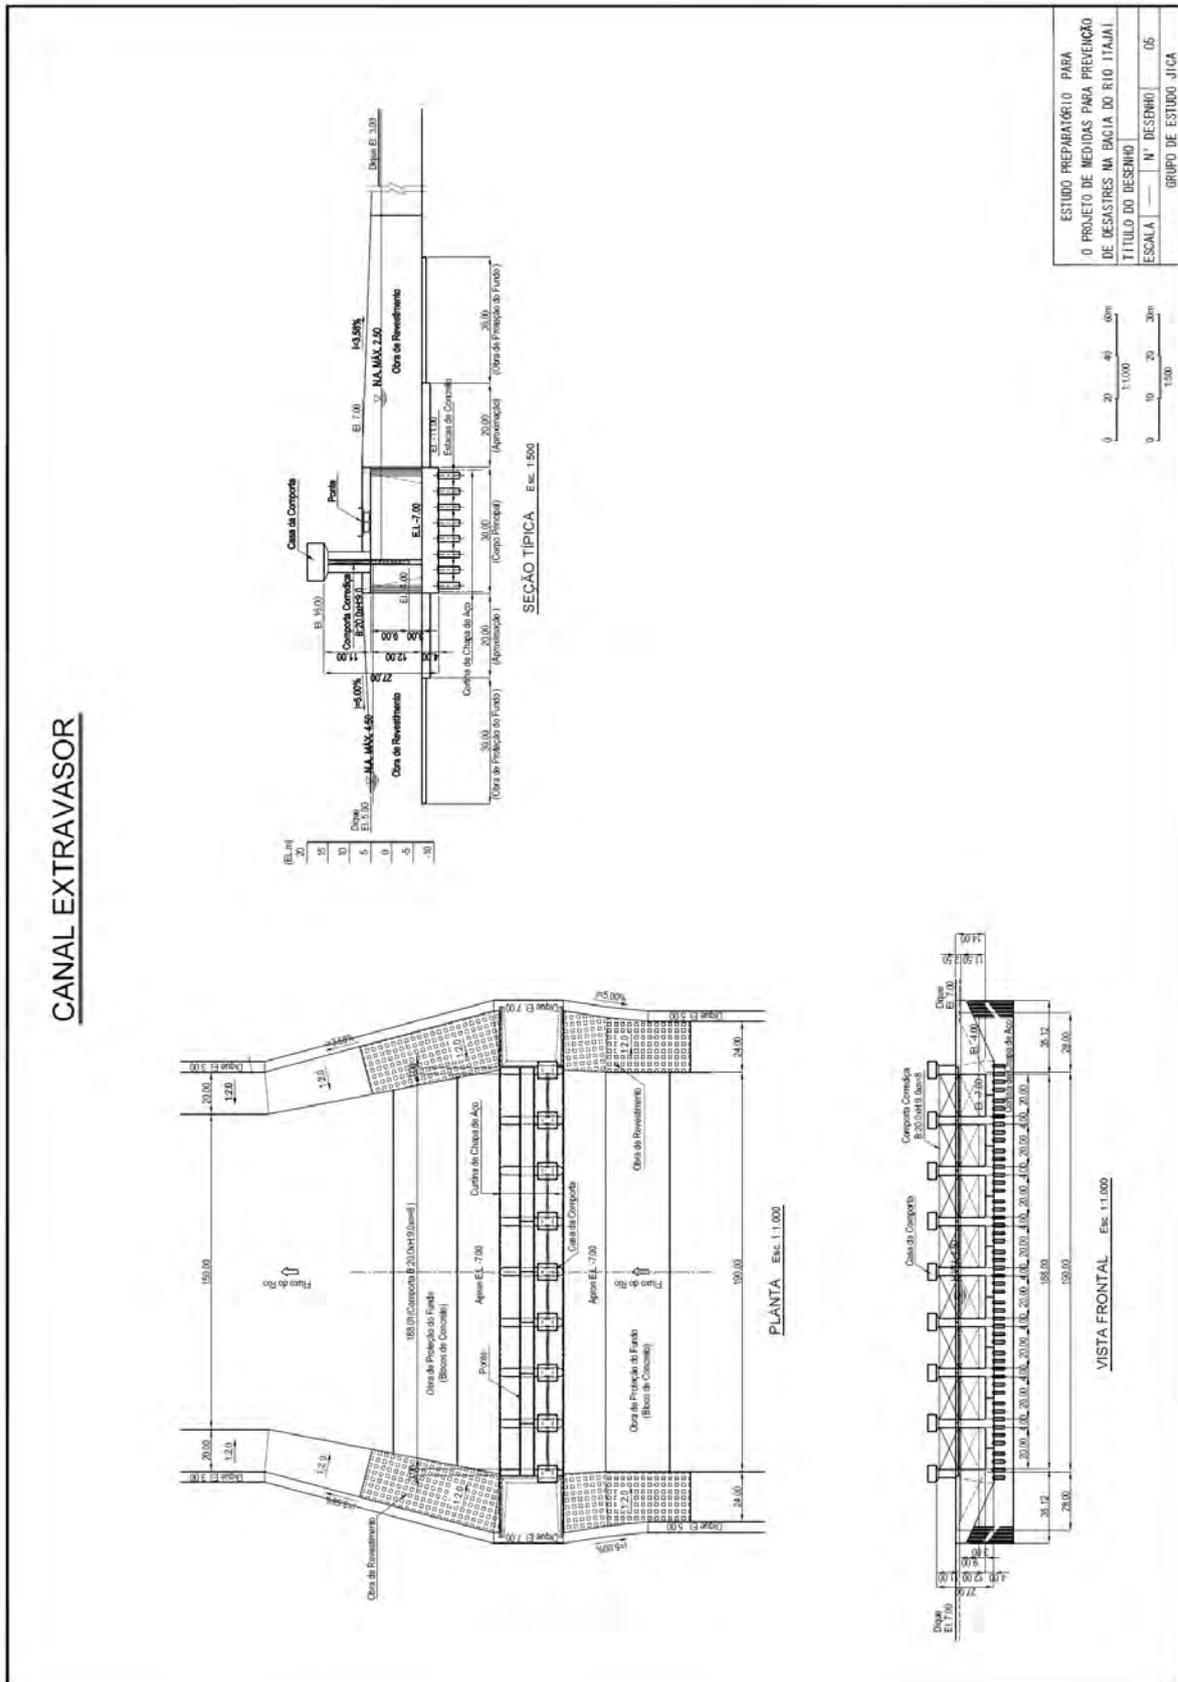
Projeto estrutural da barragem de derivação do canal extravasor
